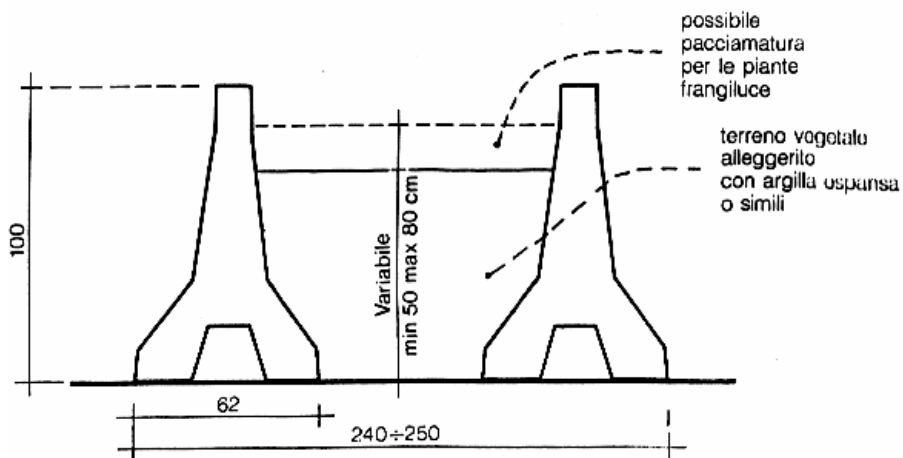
Barriera in calcestruzzo bifilare simmetrica per spartitraffico largo.
